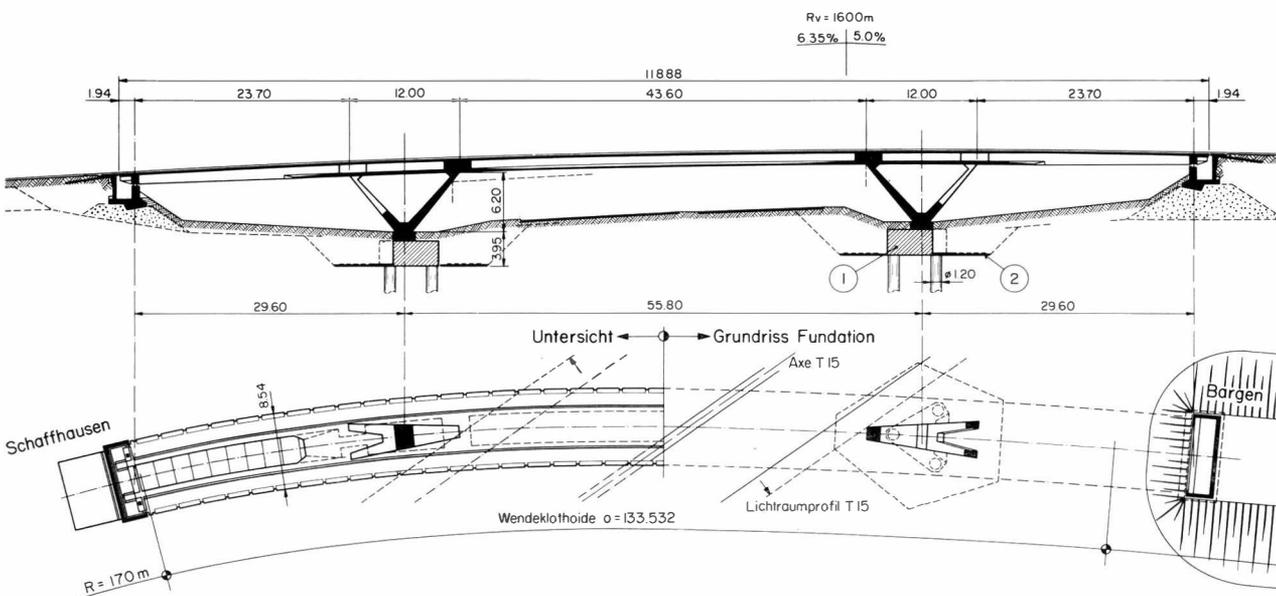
Längsschnitt und Grundriss: 1 Pfahlbankett, 2 Ankerplatte
